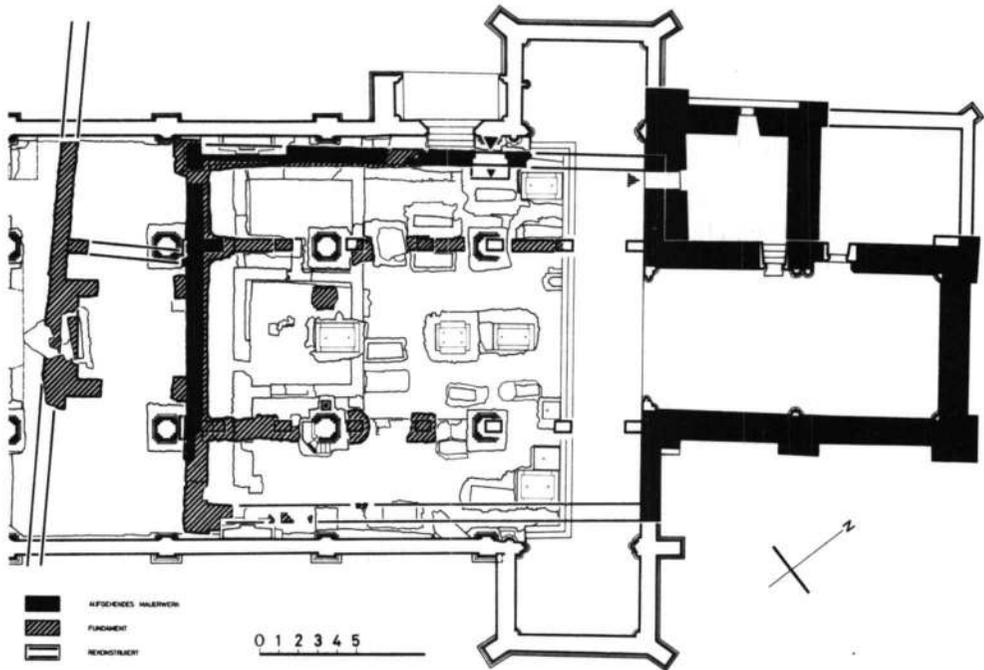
Anlage IV a: rekonstruierter Grundriss (Massstab 1 : 400).
